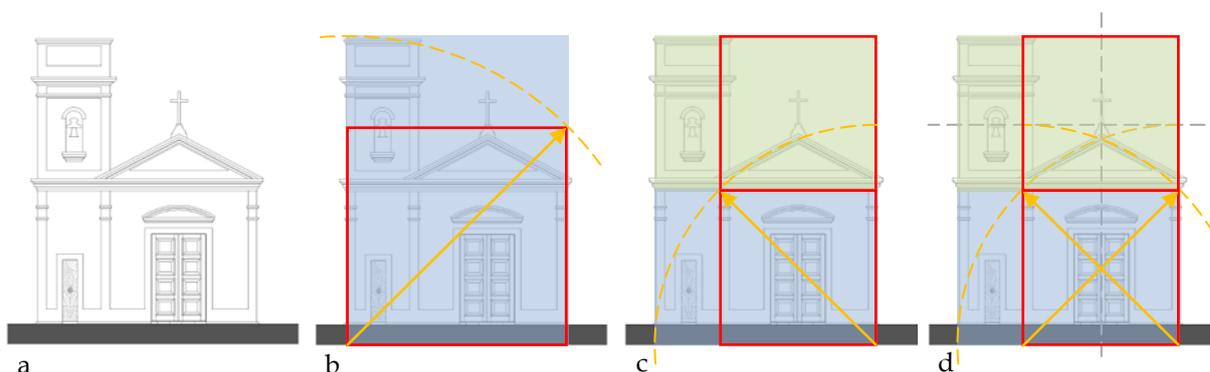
Traçado regulador da fachada frontal da Capela de Nossa Senhora da Saúde.
